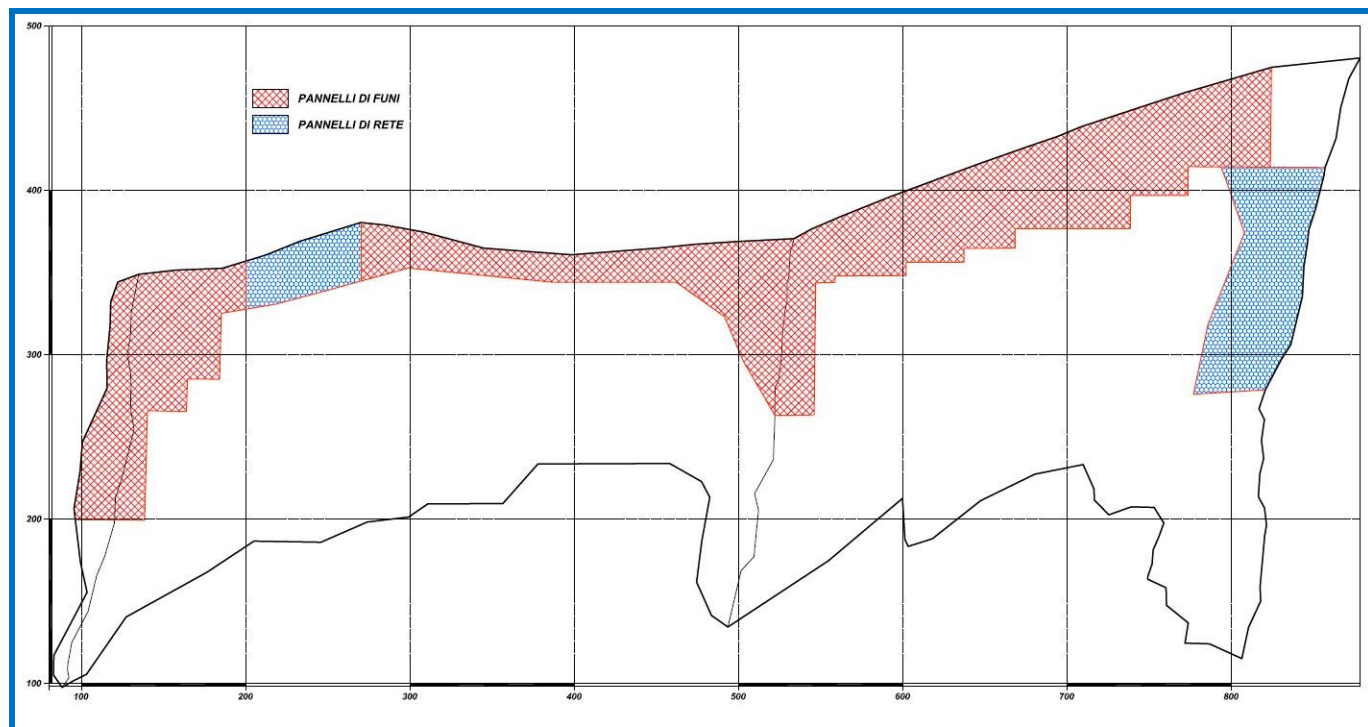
Prospetto del costone roccioso con ubicazione degli interventi attivi estesi
